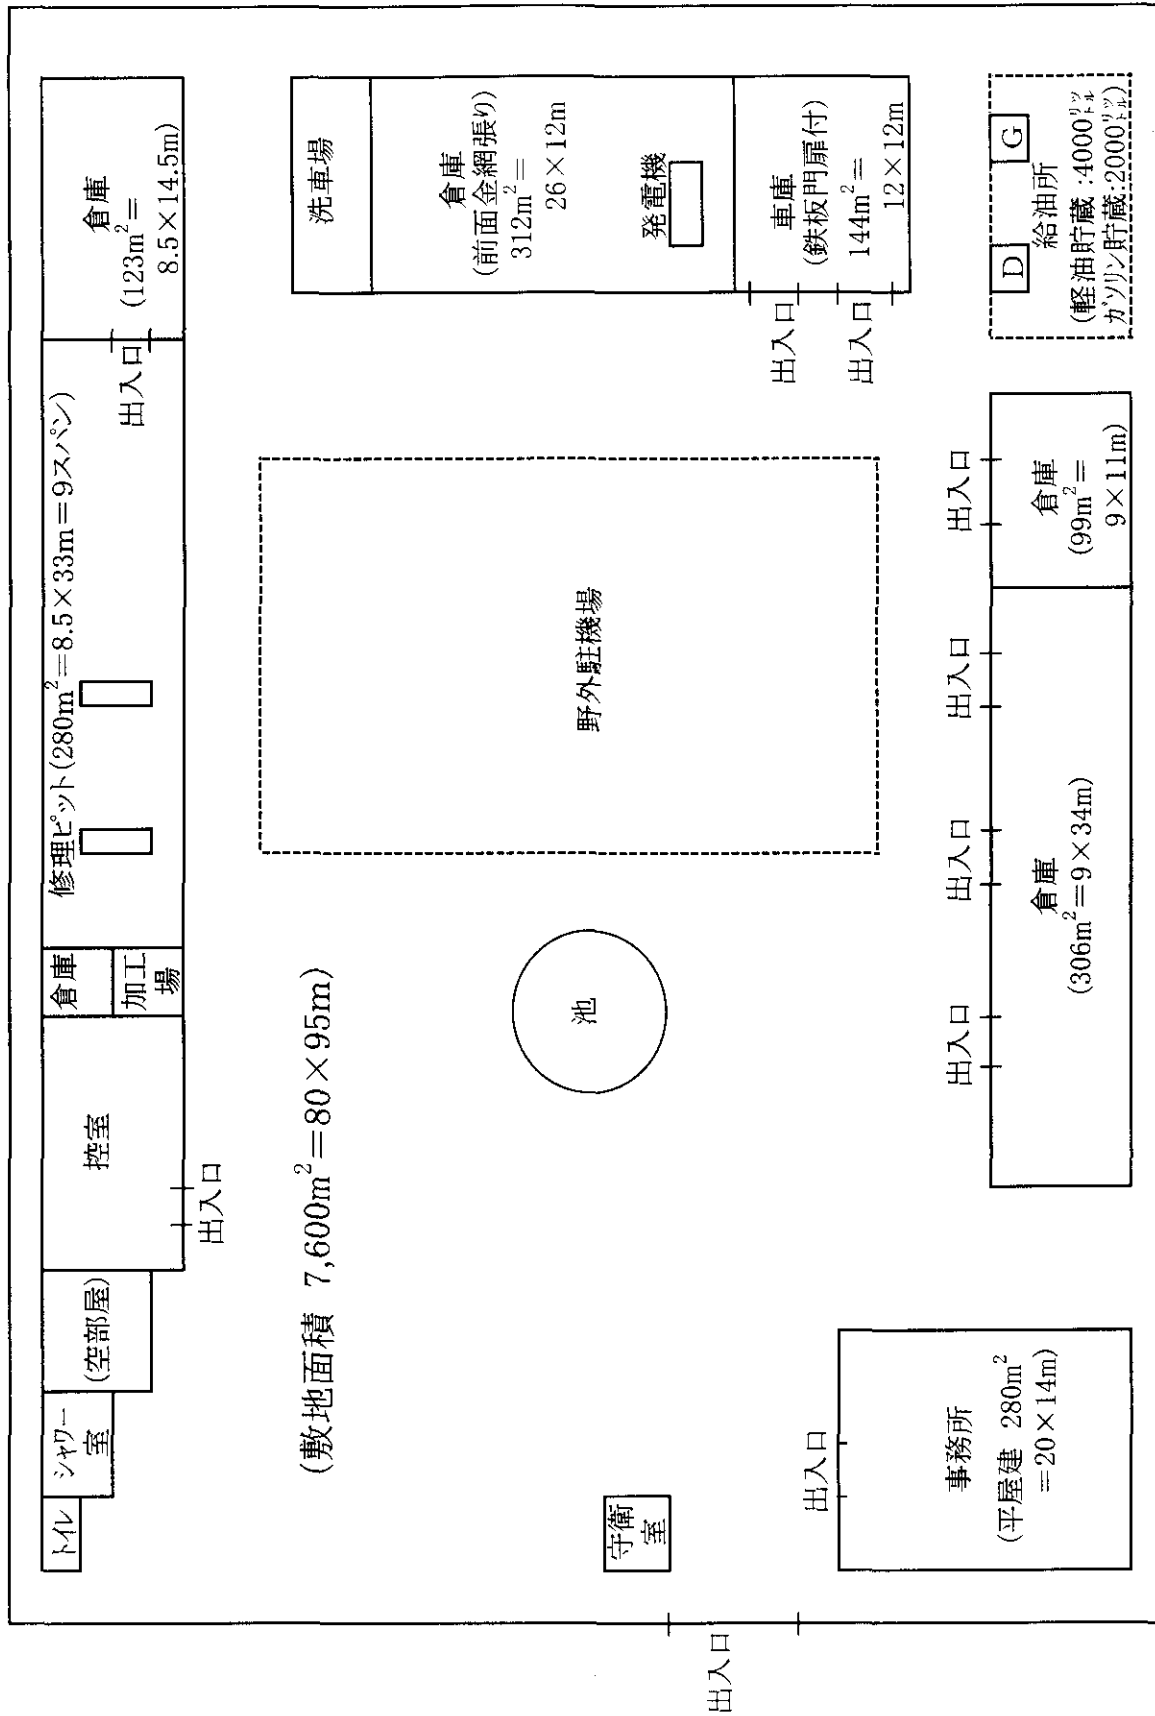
ギャンジヤ道路維持管理局 修理工場平面図
